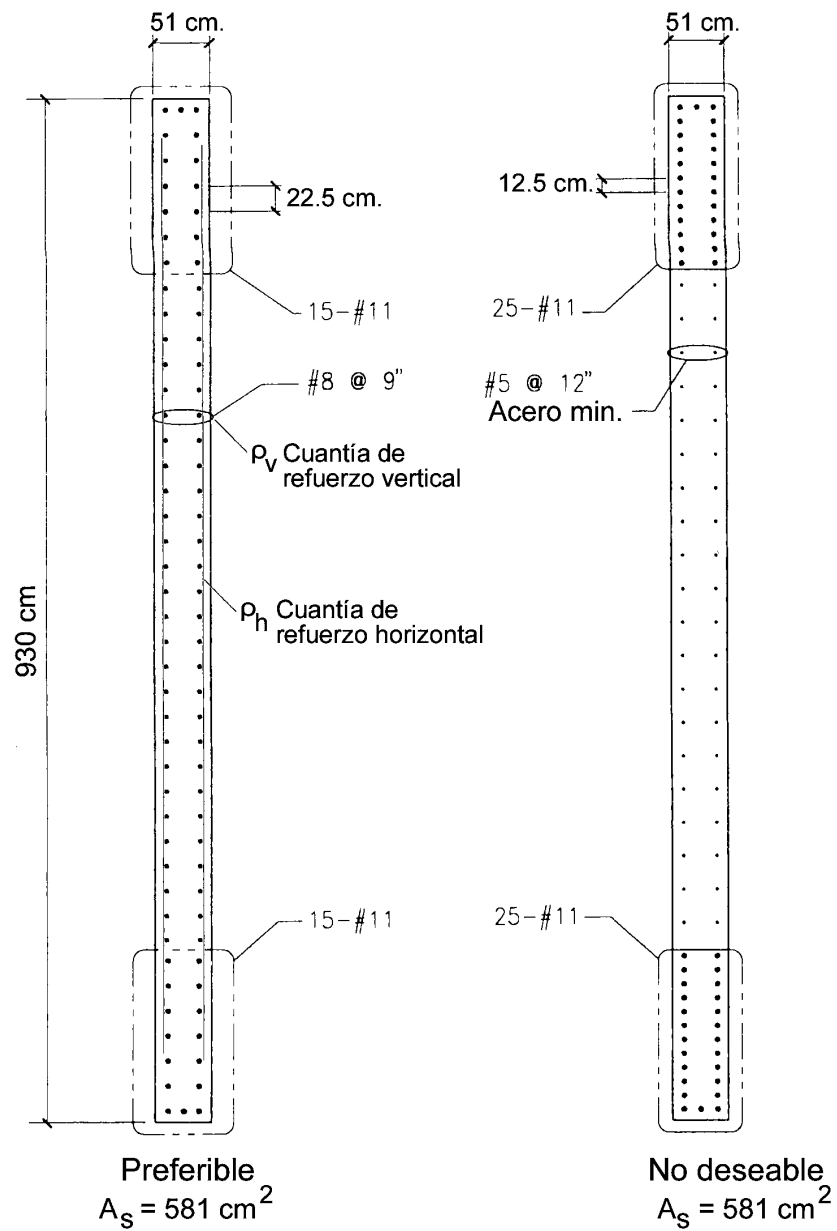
Distribución del acero de refuerzo longitudinal en la sección de un muro
